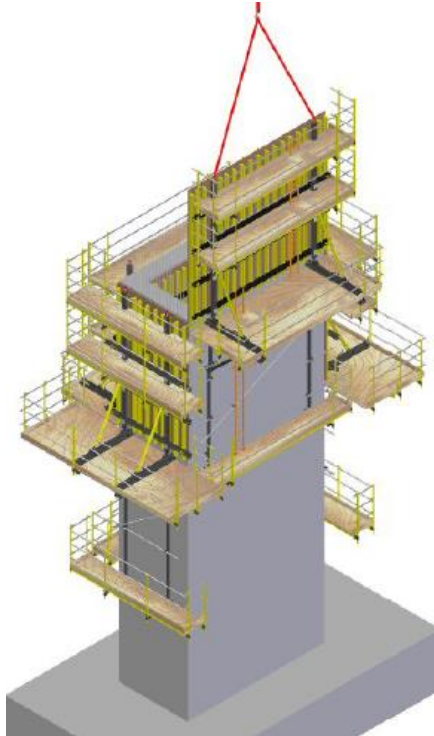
ao. Detalle de elevación conjunta de la consola y encofrado. Recuperado de: Ulma Construction, *Instrucción técnica de montaje.
